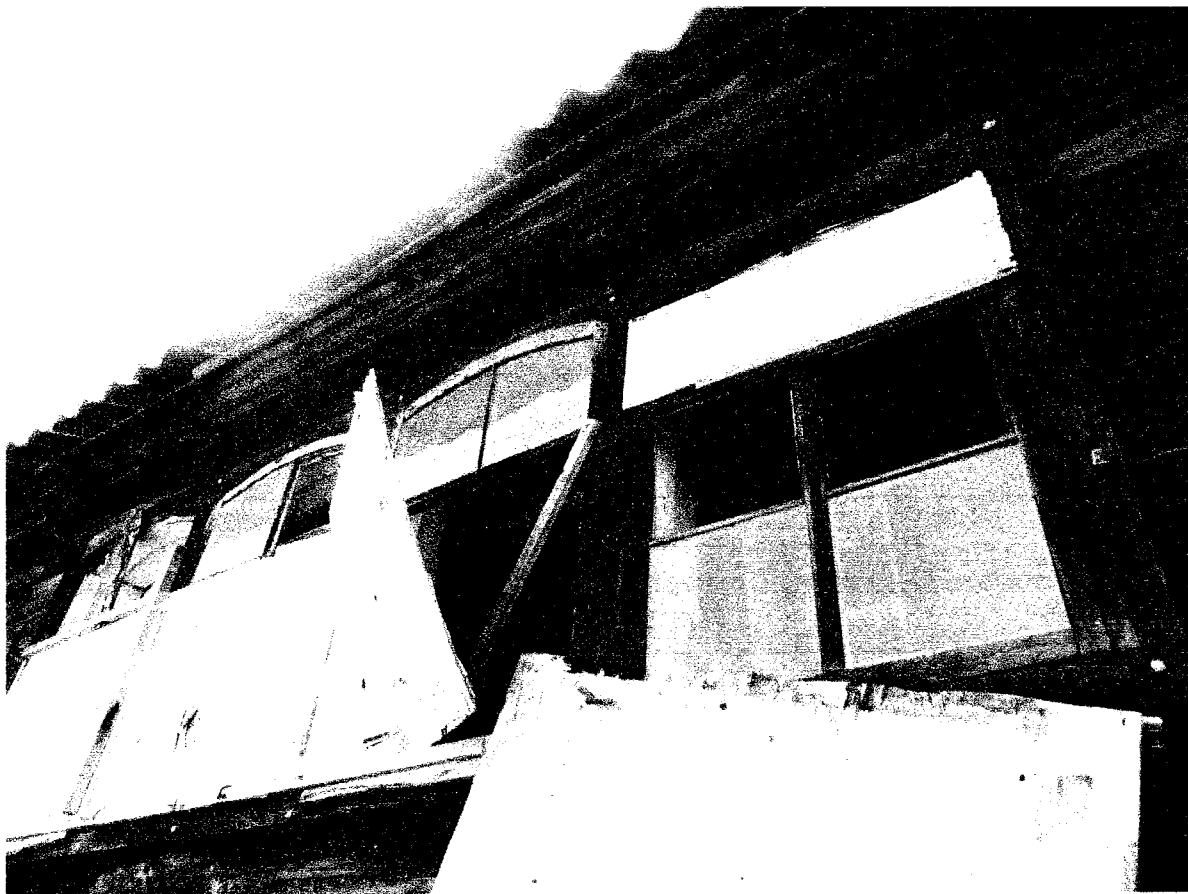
Боковой юго-западный фасад (лит.А, А1)
